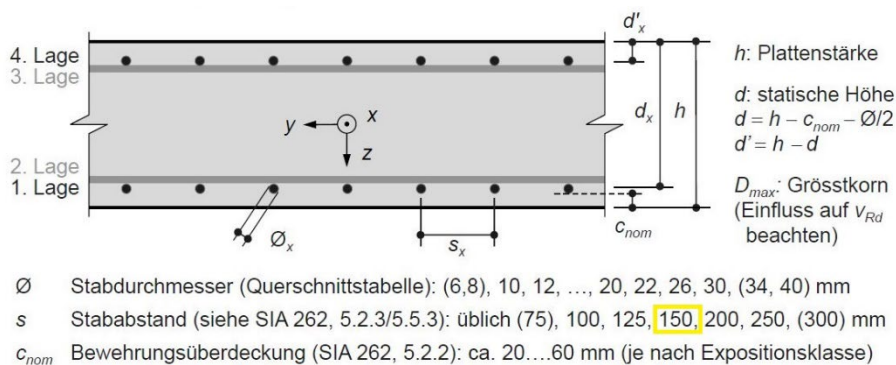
Querschnitt durch Deckenplatte mit üblicher Bewehrungsanordnung und gebräuchlichen Bezeichnungen;
